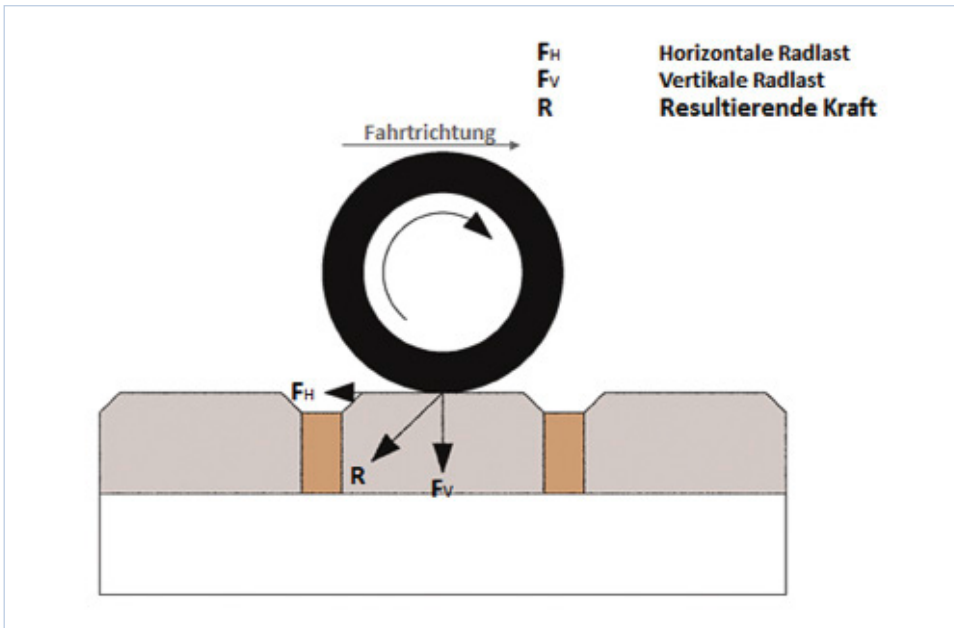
Pflasterfläche mit rollender Radlast (vertikale und horizontale Kraft) [Quelle: Buchholz]
